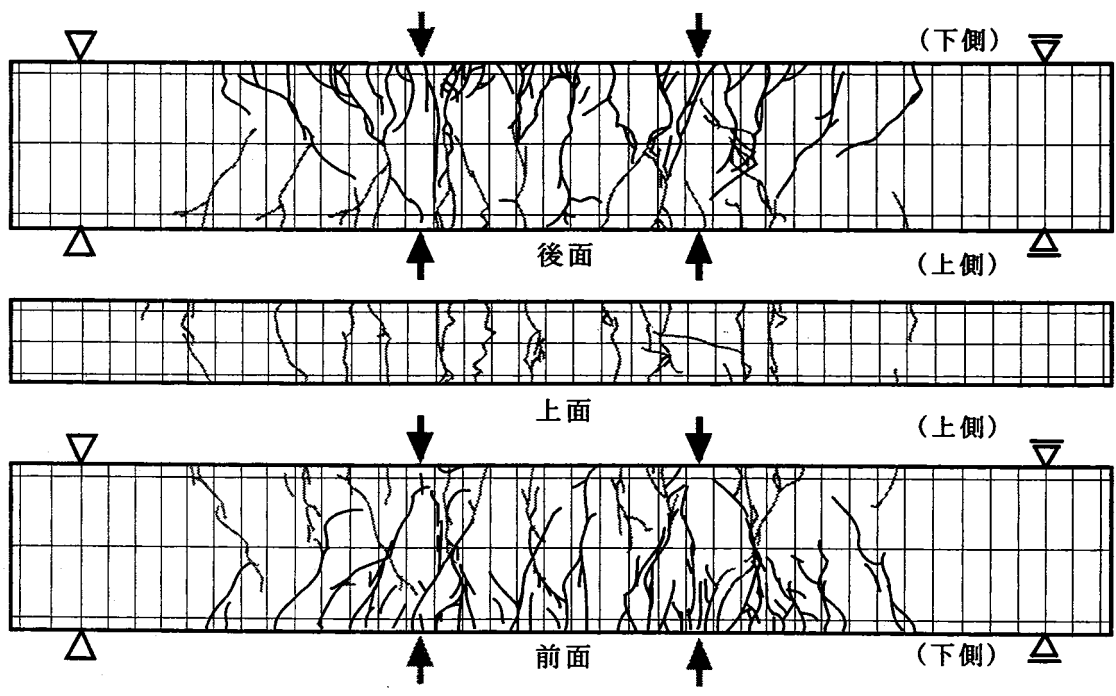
g) ひび割れ性状 [BS-2 ; 終局時]
